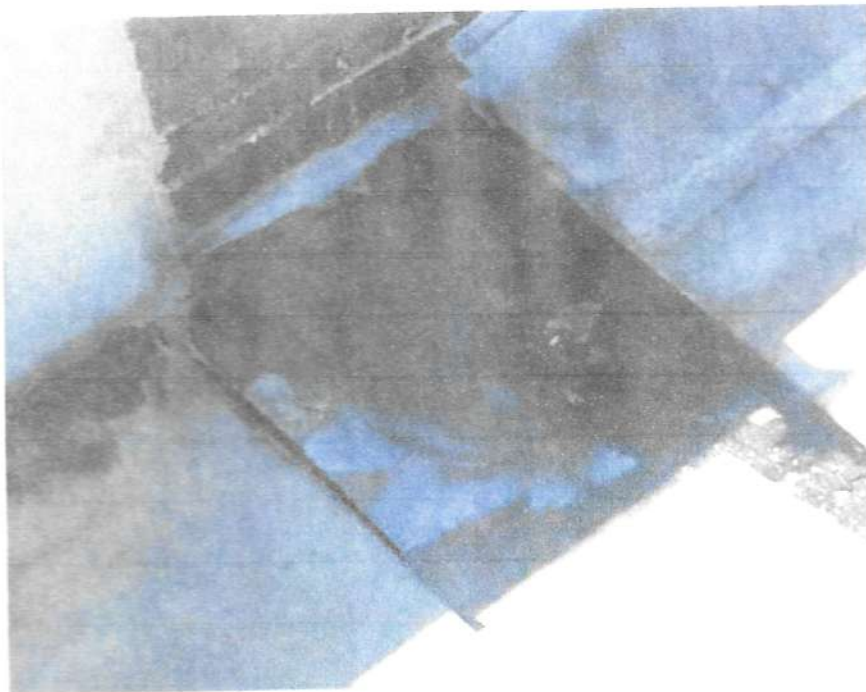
Fissura aberta entre as emendas da calha
